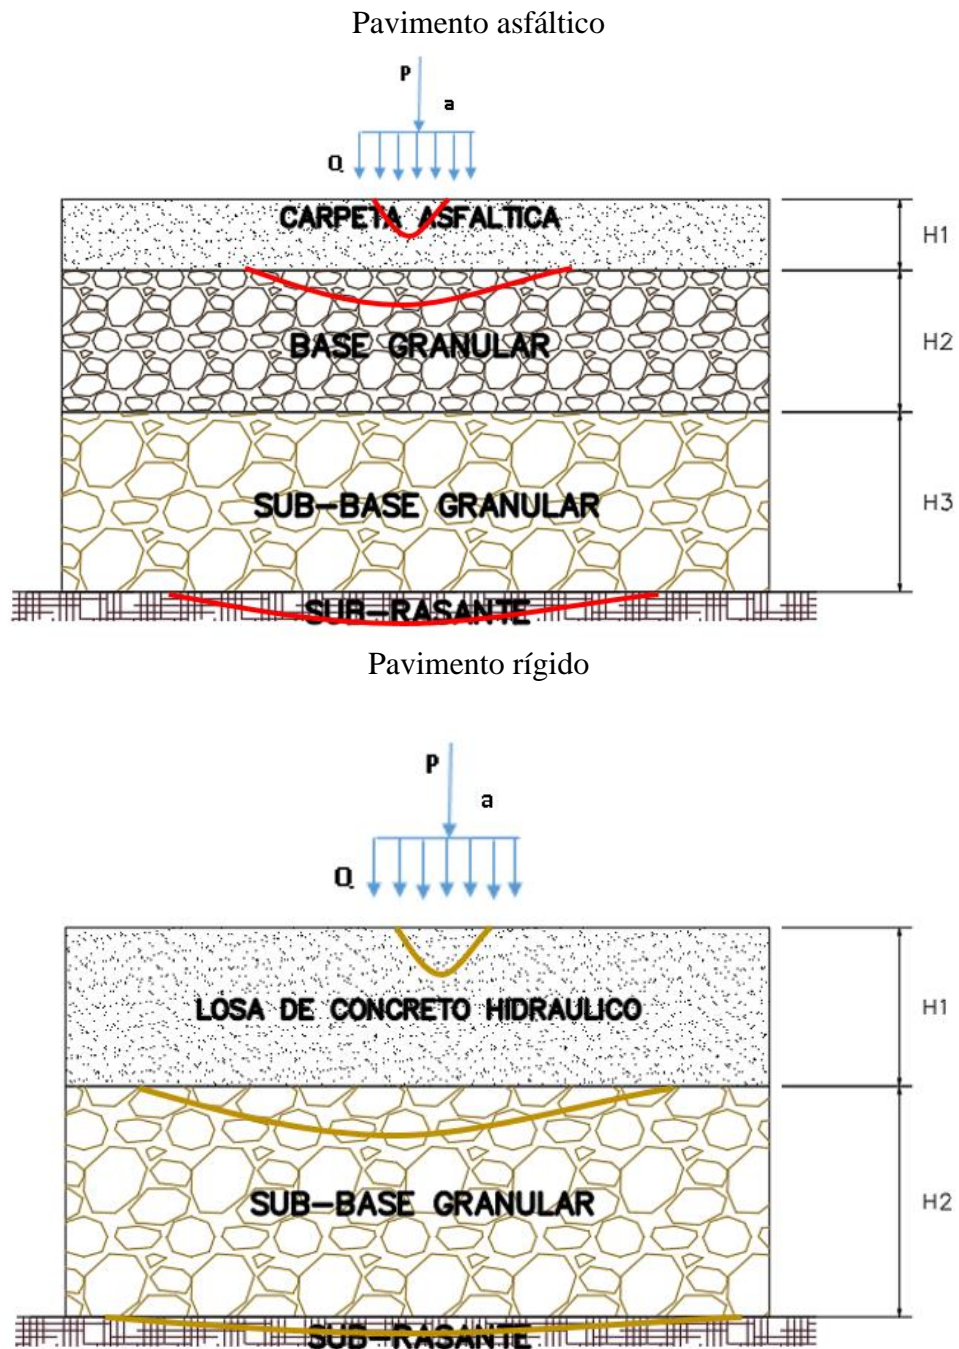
Disipación de cargas en Pavimentos semirrígidos
